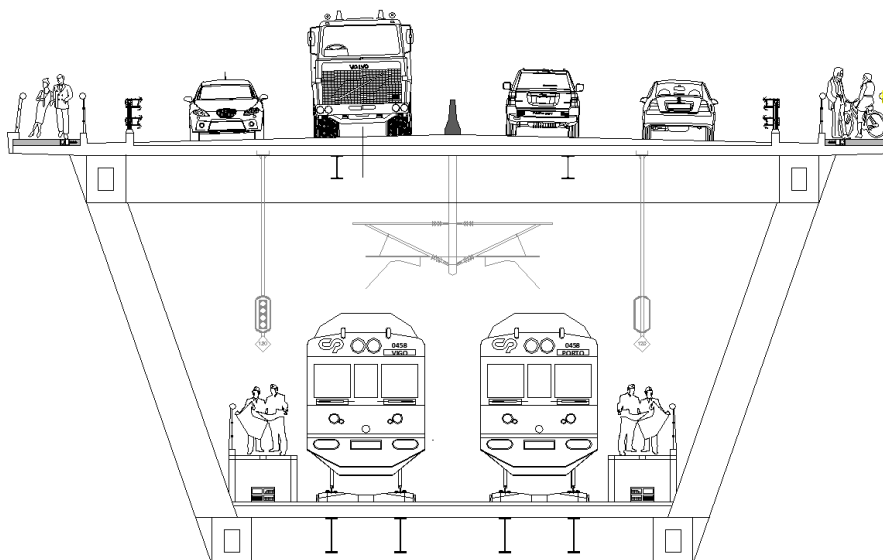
Proposta da 2ª solução da secção transversal da ponte
